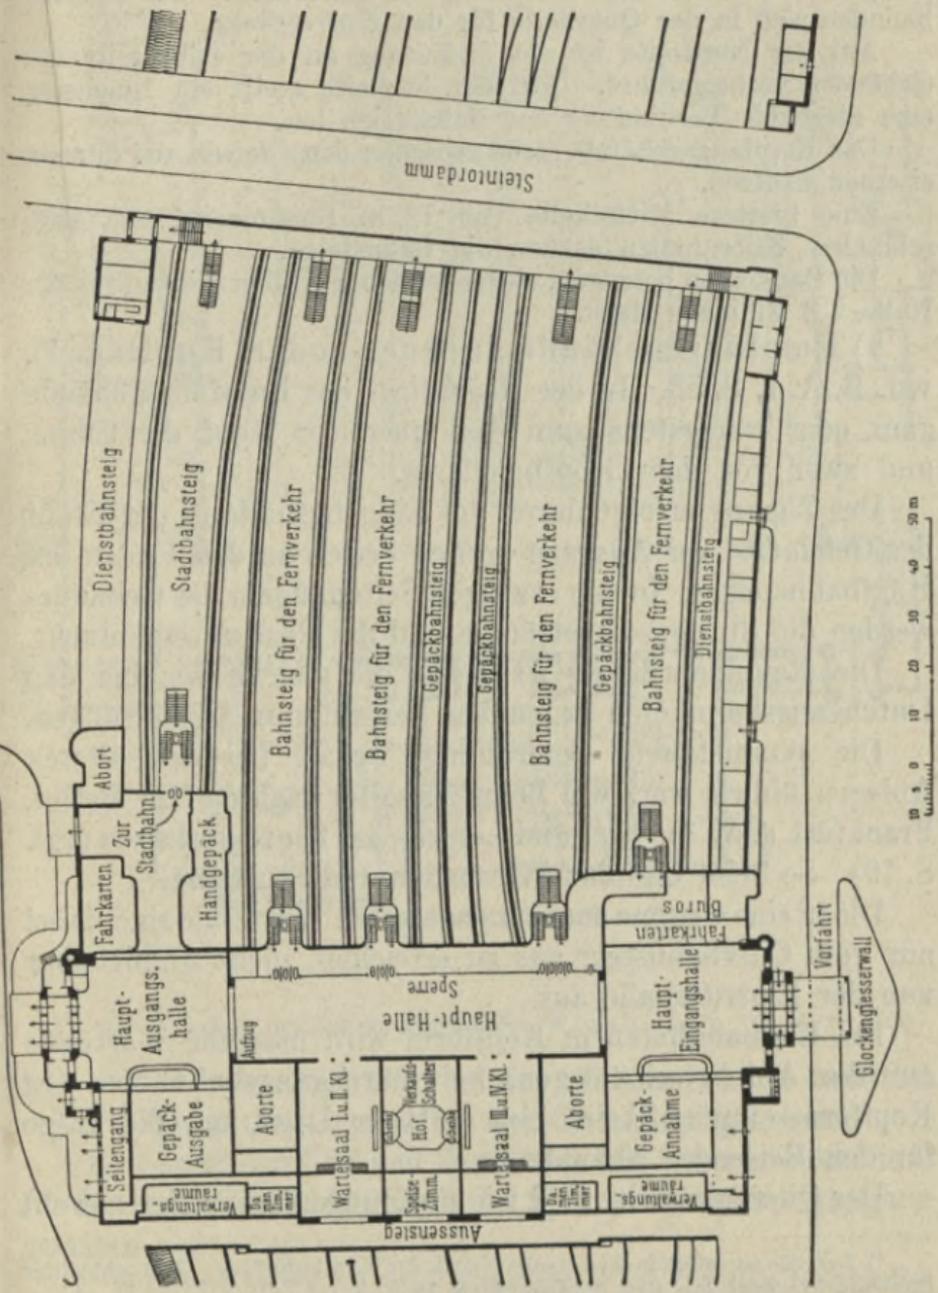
Grundriß des Empfangsgebäudes Hamburg - Hauptbahnhof. M. rd. 1 : 2100.
